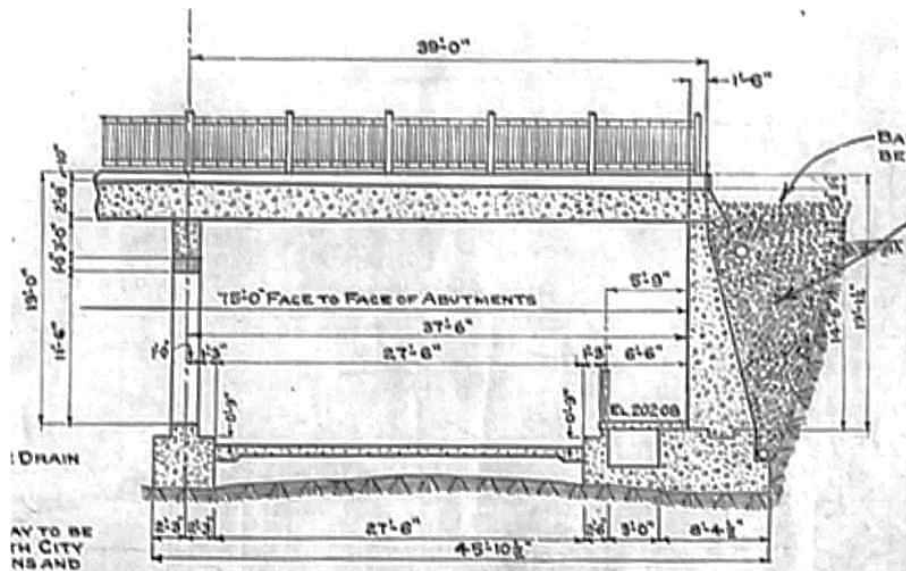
Pont d'étagement routier P.E. 81-5169A – Extrait des plans 5170-1951 - Vue en élévation d'une travée
